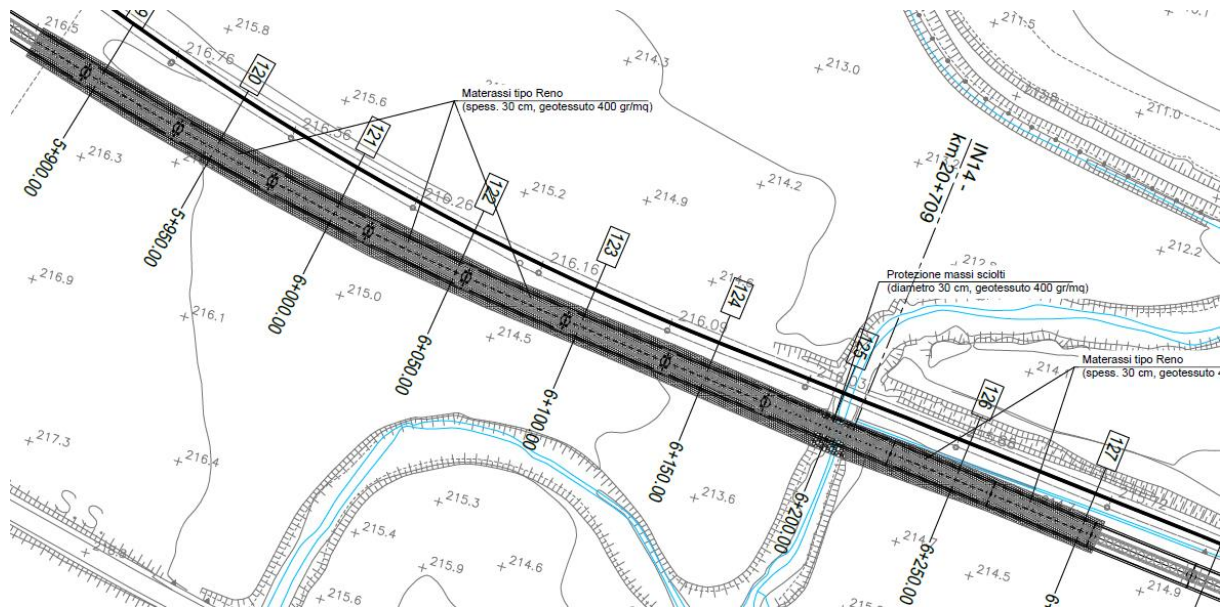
Viadotto VI06: stralcio della planimetria delle opere di sistemazione idraulica.
